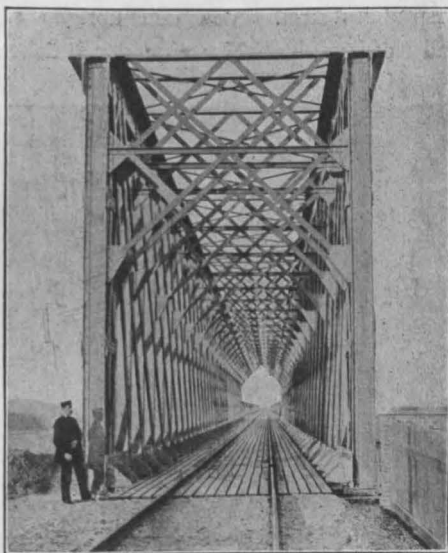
Inneres der Rheinbrücke bei Griethausen.
